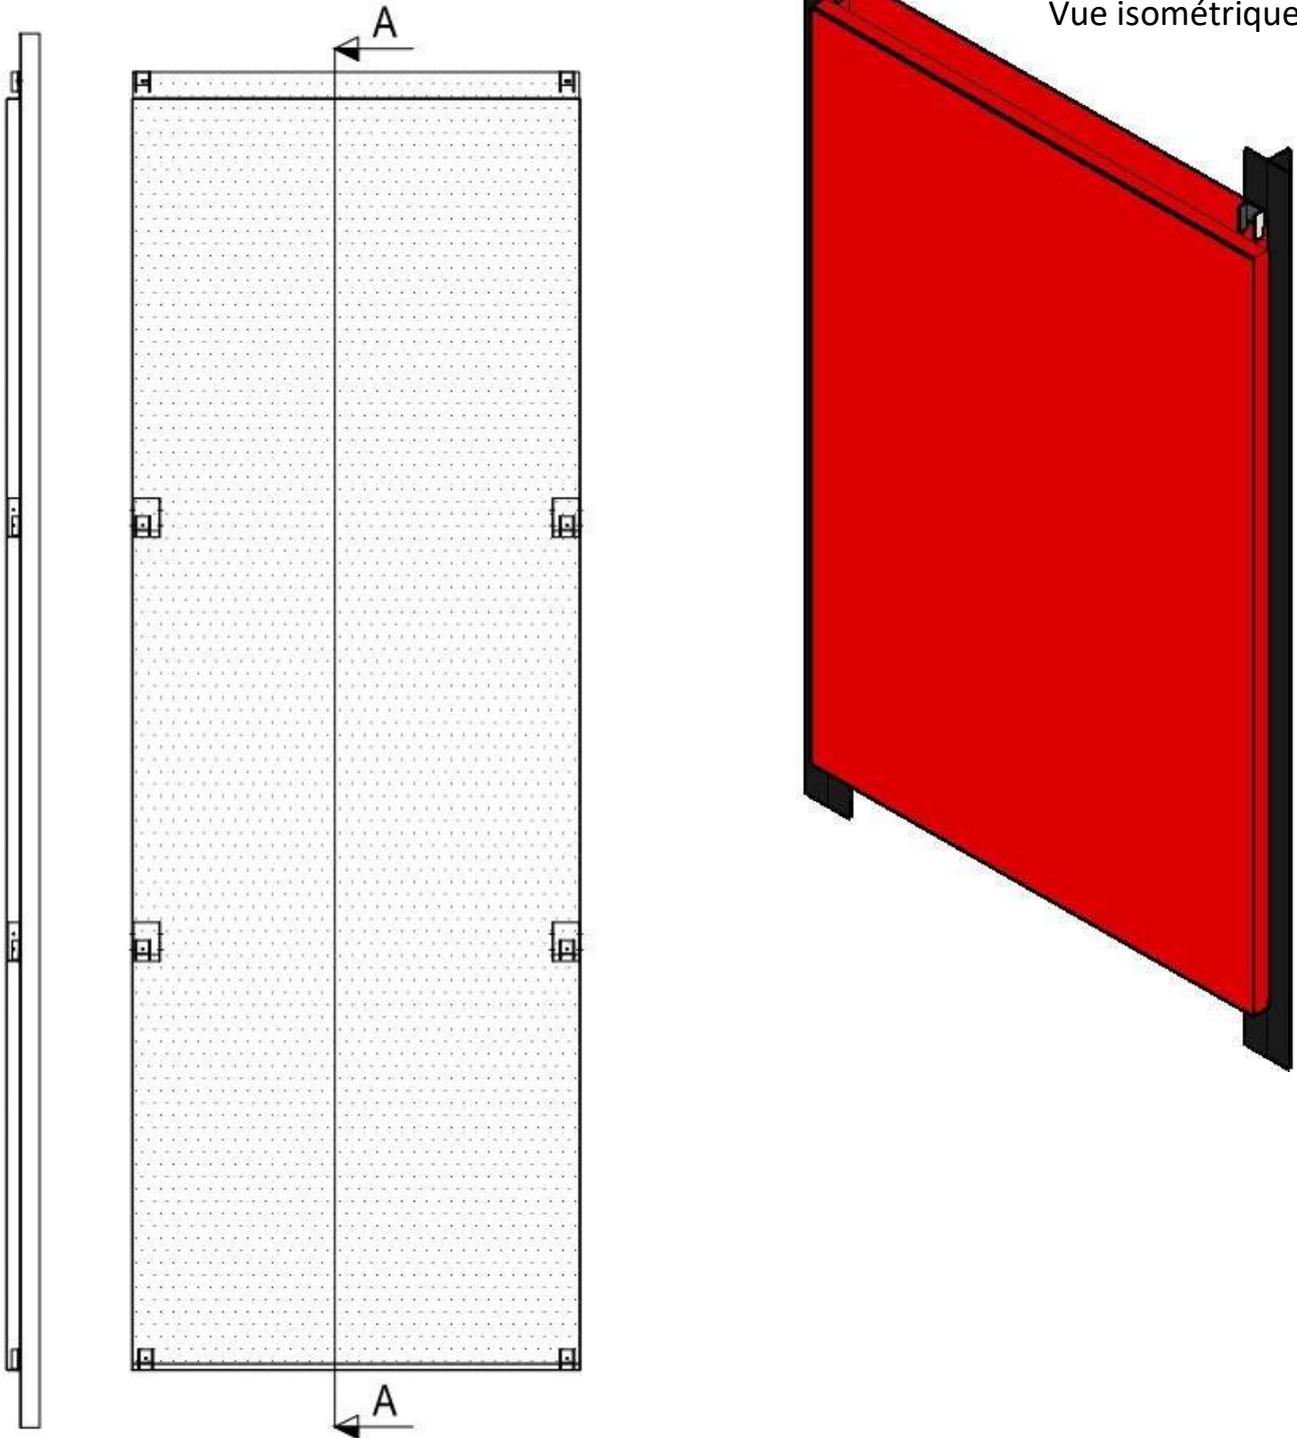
Système REVALU 1® en pose verticale sur profilé T
